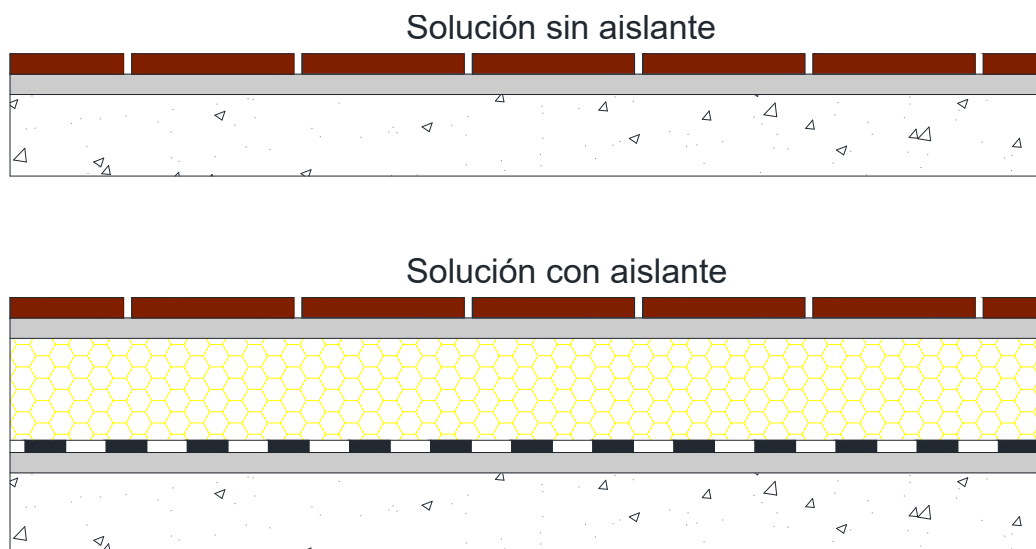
Ejemplo de actuación en cubierta plana tipo
